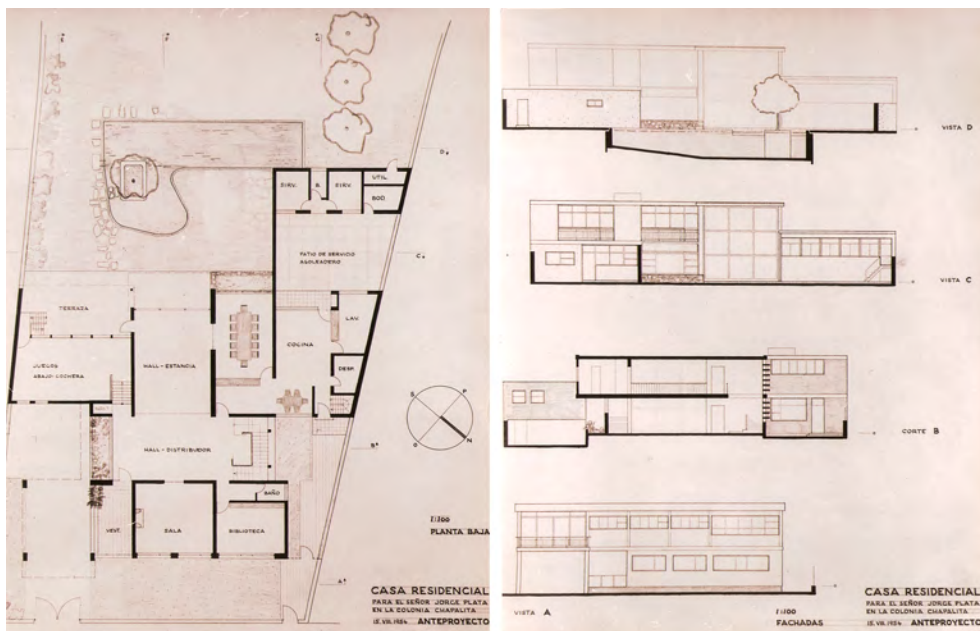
Haus Plata (1954 - 1956), Planfotografien: Grundriss Erdgeschoss, Ansichten
